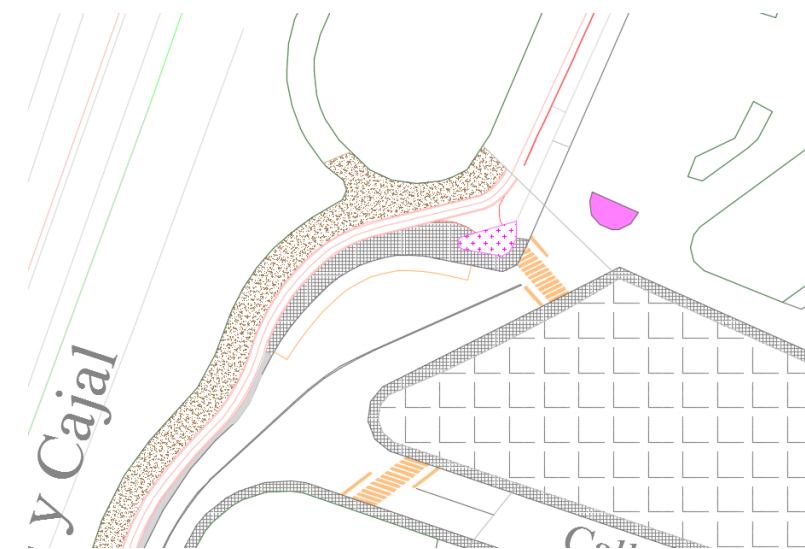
Reestructuración de la parada de autobús del Hospital de Sagunto.
